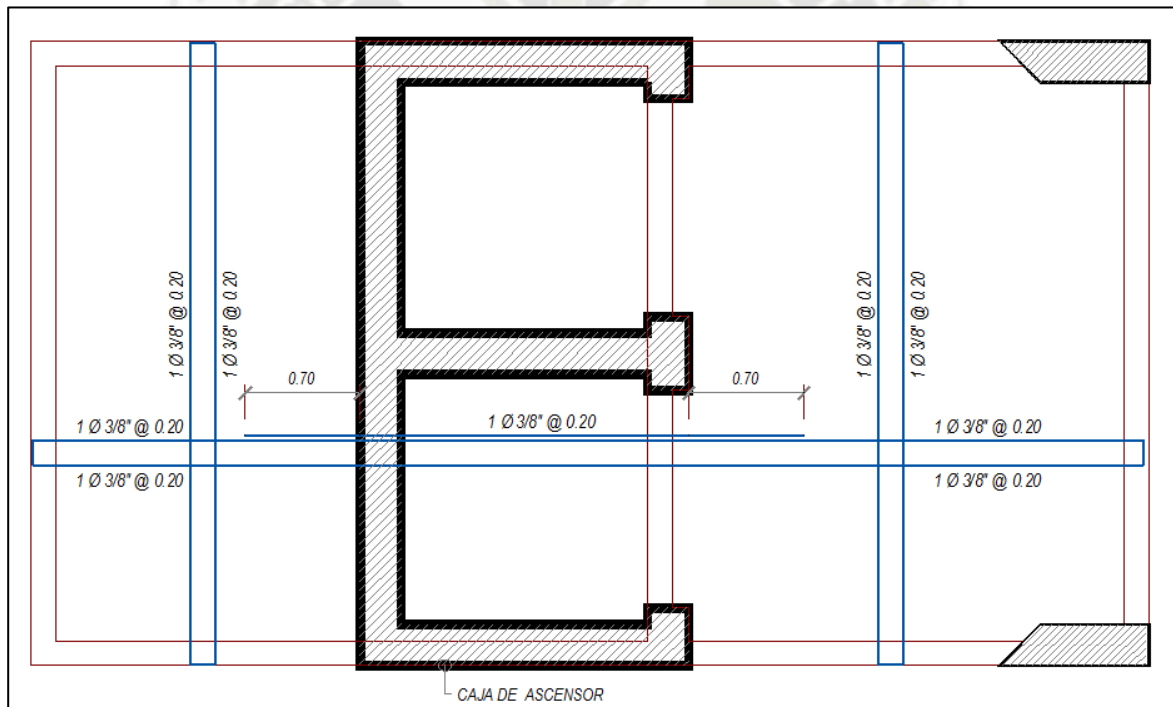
Diseño final de losa de fondo de tanque elevado y de cuarto de máquinas.
